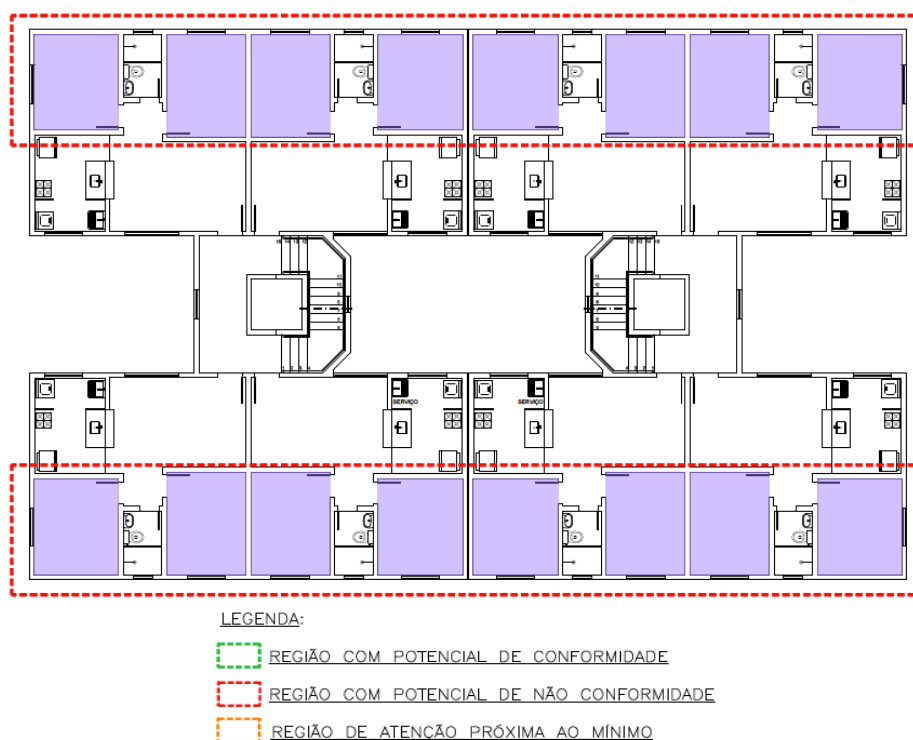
Análise de desempenho acústico - Piso - Ruído de impacto - Pavimento tipo
